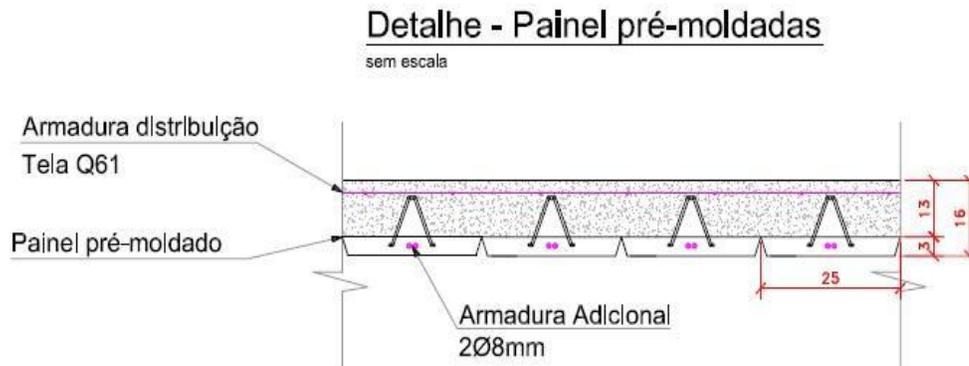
Detalhe da pré laje, tipo painel. Sem escala.
